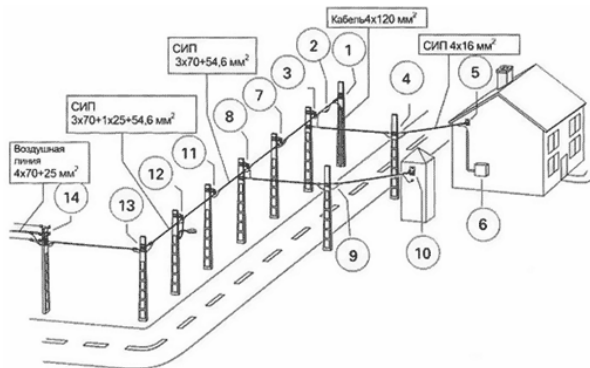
Типовая схема ВЛИ СИП-2А: 1 — анкерное крепление и соединение СИП с силовым кабелем; 2 — соединение проводов СИП; 3 — промежуточная арматура СИП и абонентское ответвление; 4 — анкерная арматура для СИП абонентов; 5 — арматура для прокладки СИП по фасадам зданий; 6 — окончание СИП абонентов; 7 — промежуточная арматура СИП и арматура для повторного заземления; 8 — промежуточная арматура и арматура для основного ответвления СИП; 9 — двойное анкерное крепление СИП при отклонении направления трассы больше 100° и установка ограничителей перенапряжения; 10 — ввод СИП в ТП и подключение к трансформатору; 11 — промежуточная арматура СИП для основной линии; 12 — промежуточная арматура СИП и присоединение уличного освещения; 13 — двойное анкерное крепление СИП при отклонении направления трассы 90°; 14 — анкерная арматура и зажимы для присоединения СИП к голым проводам
